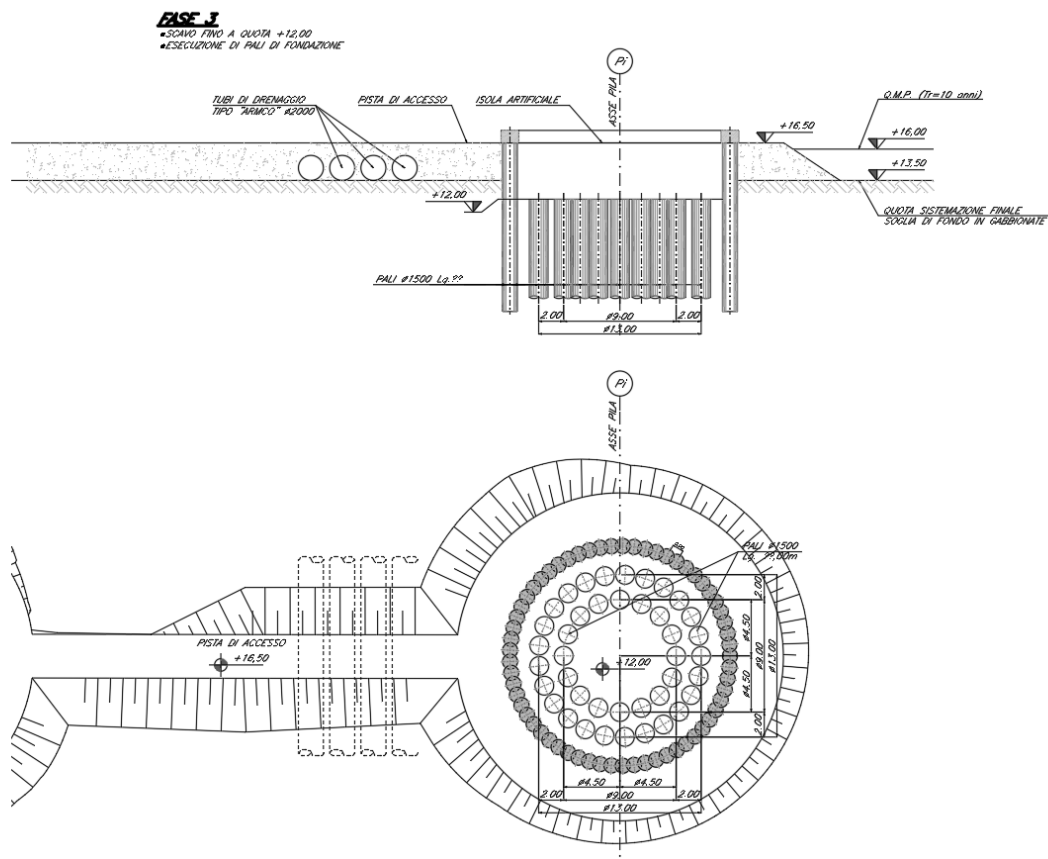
sezione trasversale e pianta dell'opera di presidio per lo scavo dei pozzi di fondazione del viadotto VI07
